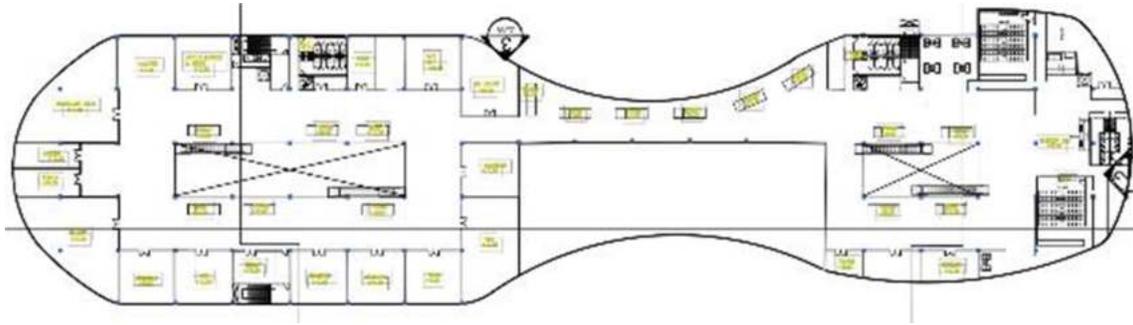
, Pembagian zona dalam bangunan (denah lantai dasar)
